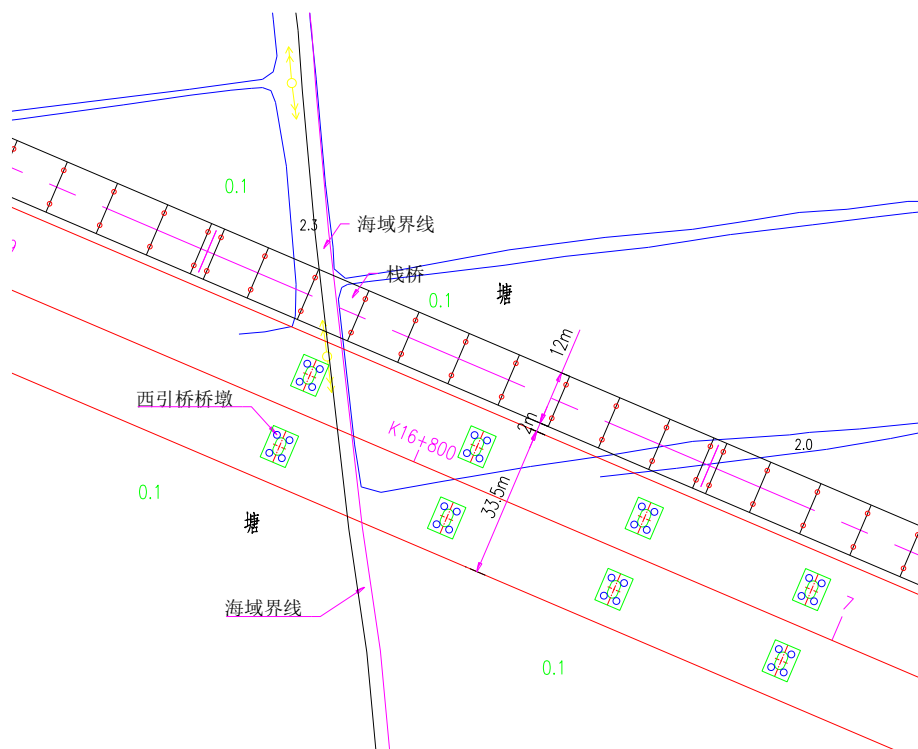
穿越西岸台山侧海域界限平面图
